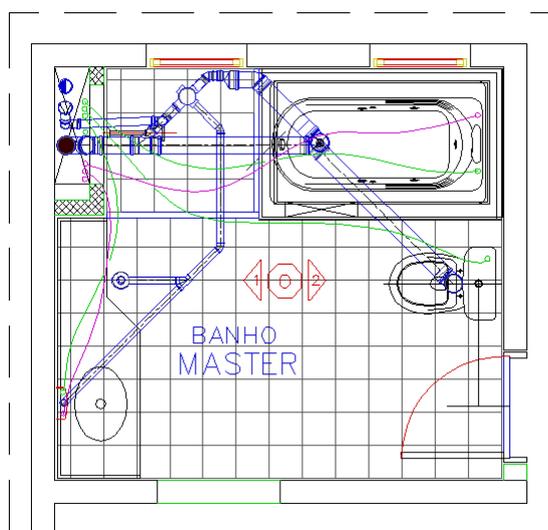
Esquema em planta baixa da distribuição dos subramais em PEX sob a laje.
